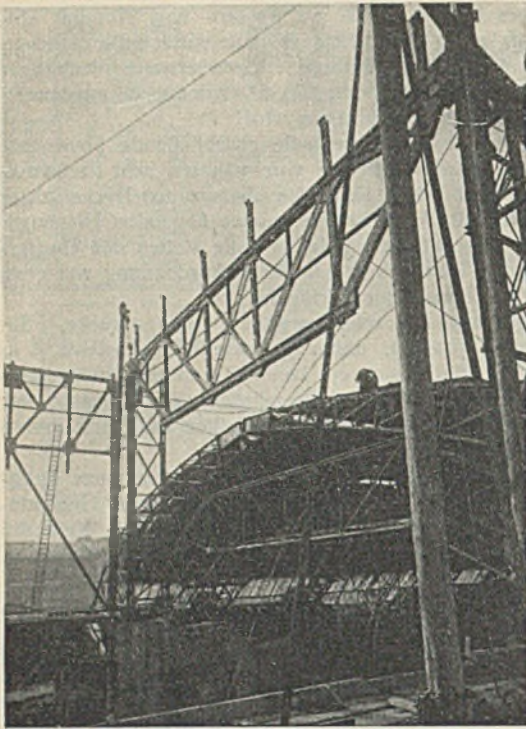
Unterzug der Bühnenhausschürze in endgültiger Lage.
